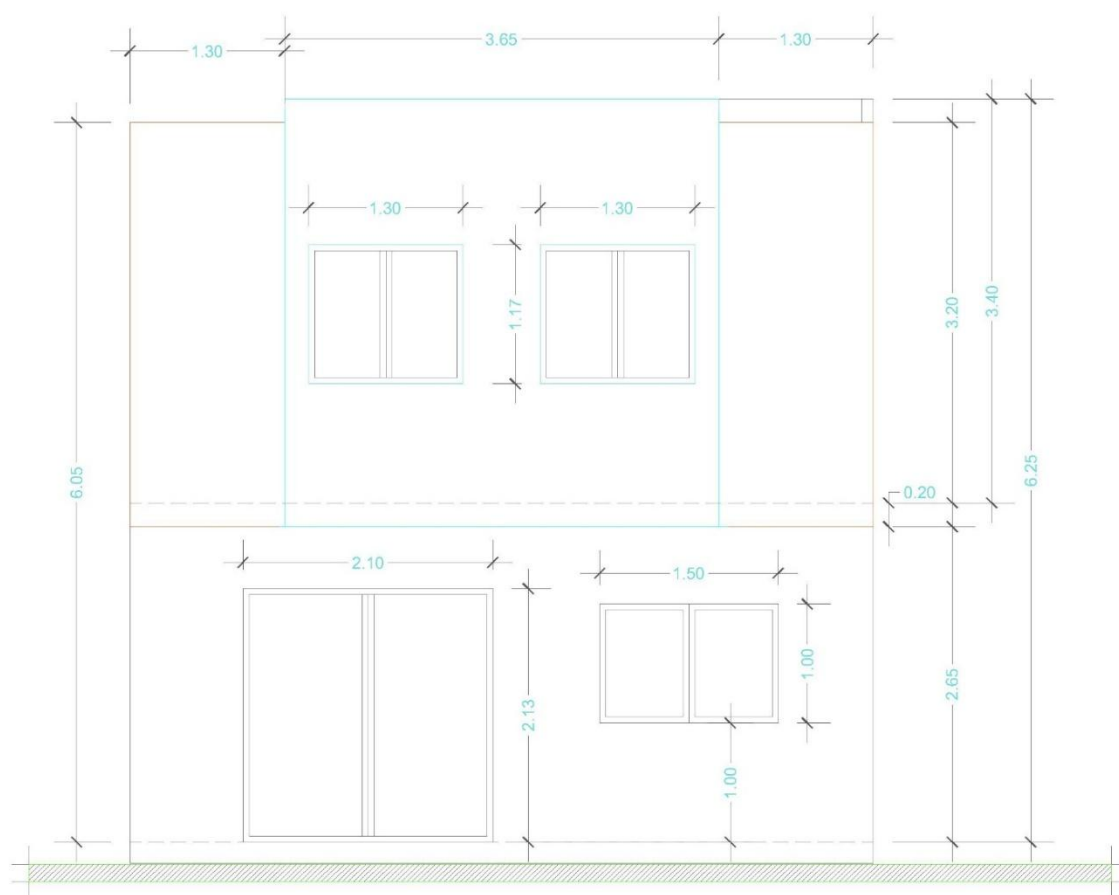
Planos arquitectónicos vivienda de hormigón armadoNota.* Proporcionado por arquitecto de la vivienda.
